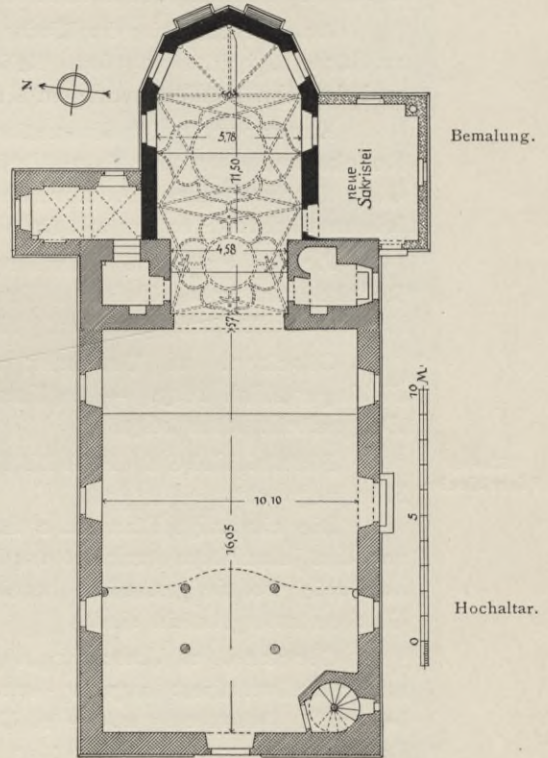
Büchold. Grundriß der Pfarrkirche.
